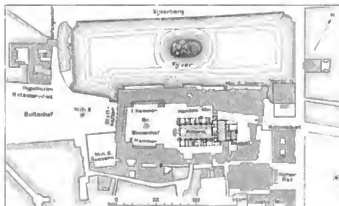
Binnenhof. Lageplan und Grundriß im Jahre 1891.
